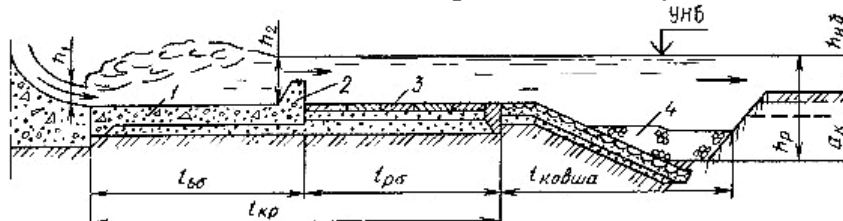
Крепление НБ - гладкий водобой со стенкой и рисберма с ковшом
